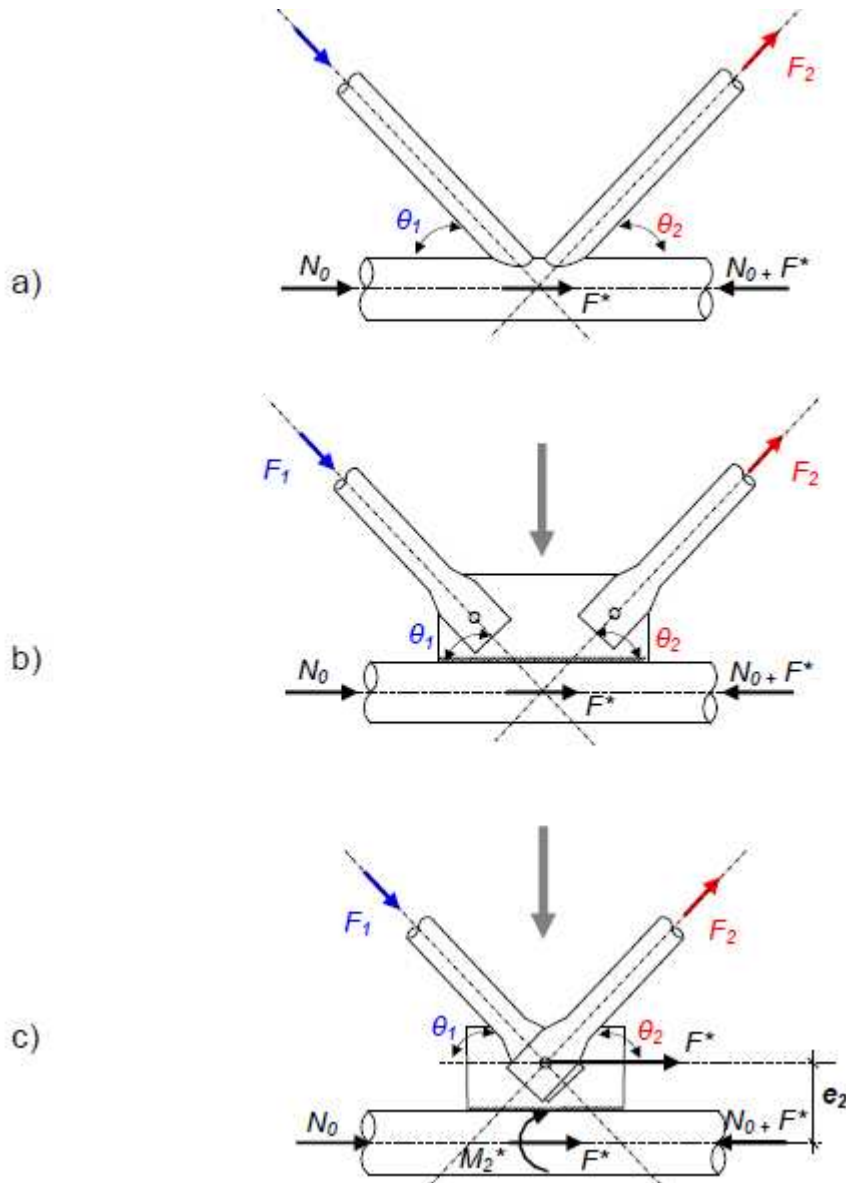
Esquema ligações planares por MINCHILLO (2011)
